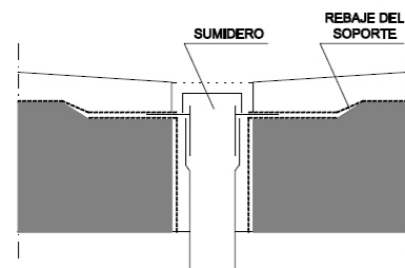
Rebaje del soporte alrededor de los sumideros
